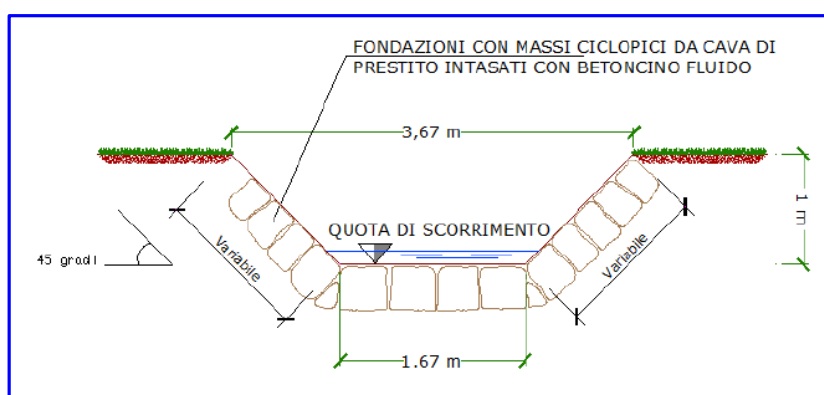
Dimensioni del canale a sezione trapezia realizzata (realizzazione in Auto-CAD).
